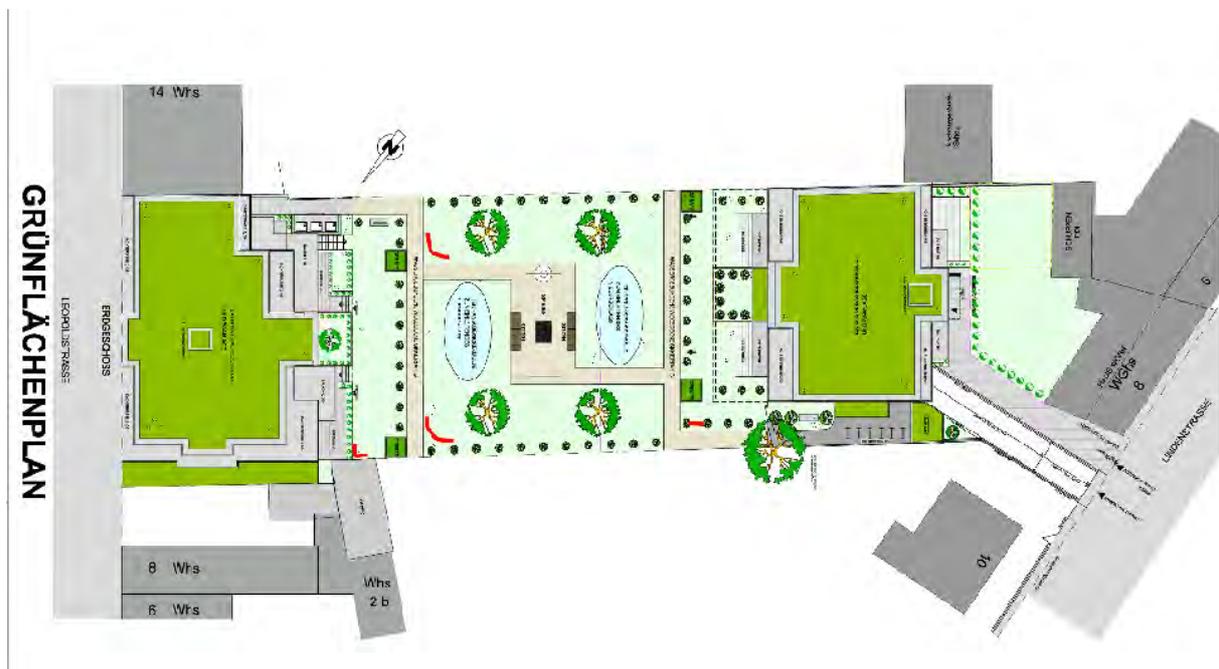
Übersicht Grünflächenplan (2025) mit der Lage der Trockenmauern (rote Linien).
